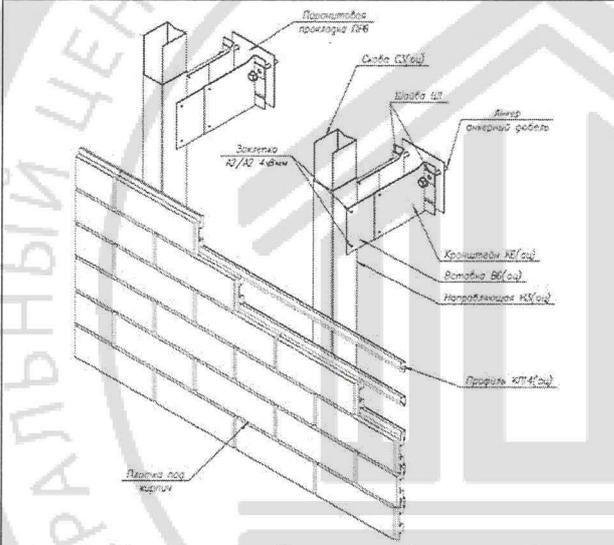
Система с облицовкой плиткой под кирпич на профиль КП14(оц) (крепление в межэтажные перекрытия)
